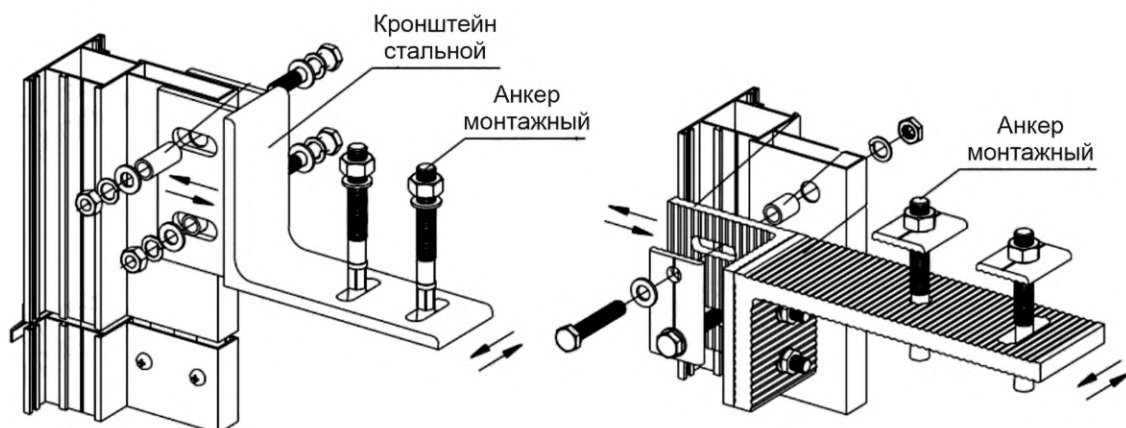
Крепление стоек алюминиевой составной или охватывающей стальной кронштейн с опорой на плиту перекрытия и охватом пилона стойки
